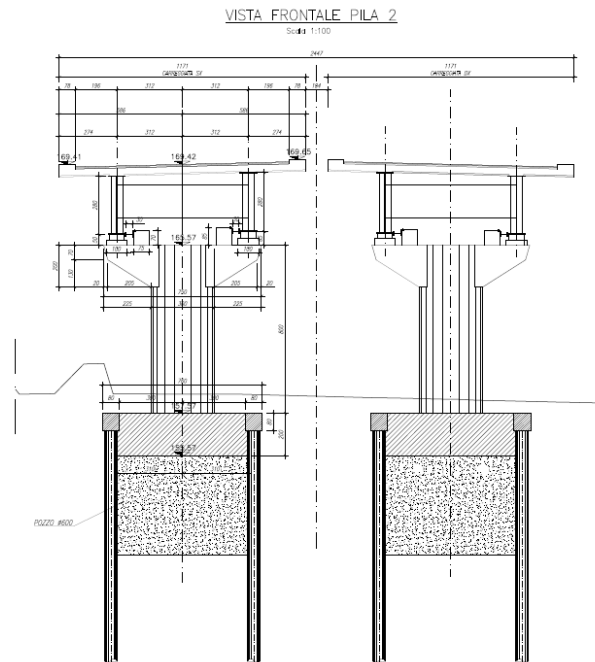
Sezione trasversale pile Viadotto sul fiume Merse
